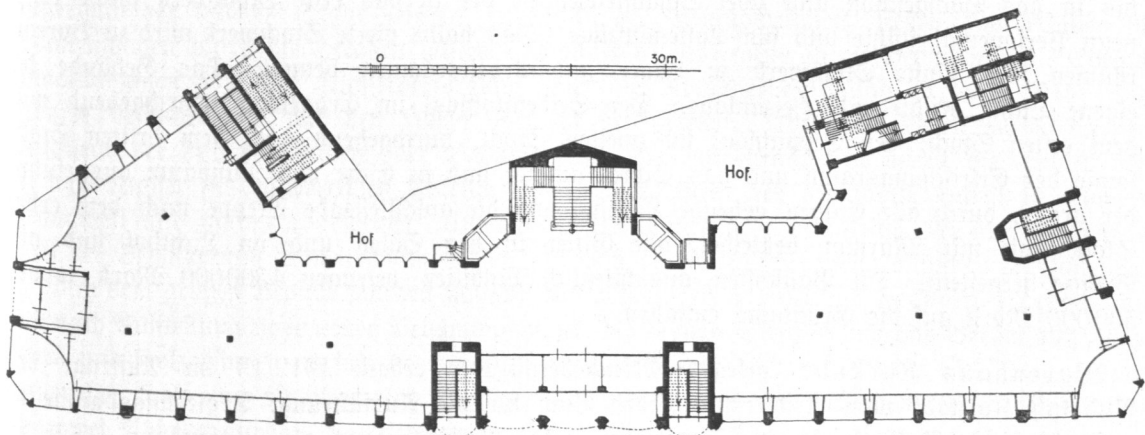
Warenhaus Karstadt, Erdgeschosj.
